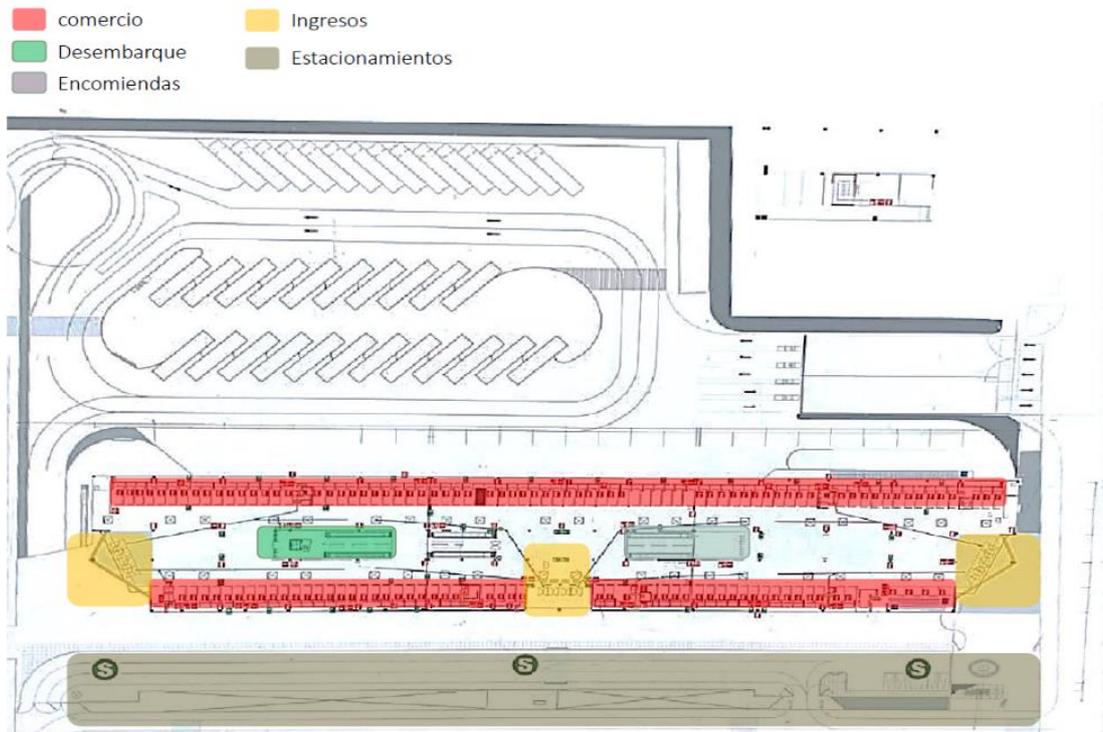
Gran Terminal Plaza Norte Primera Planta NPT ±0.00
